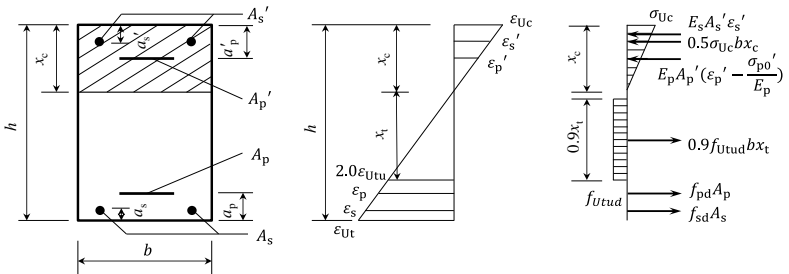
配置纵向普通钢筋及预应力钢筋的矩形截面超高性能混凝土受
